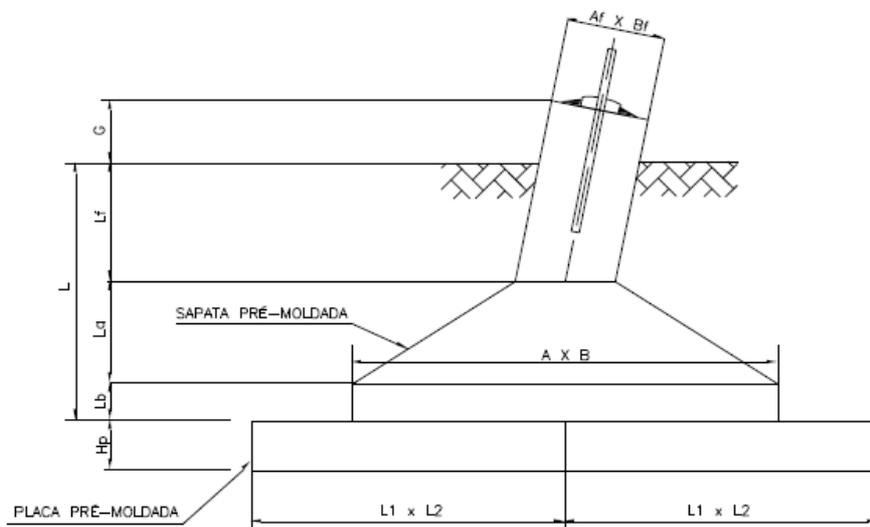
Layout da fundação tipo sapatas com ou sem placa pré-moldada.
